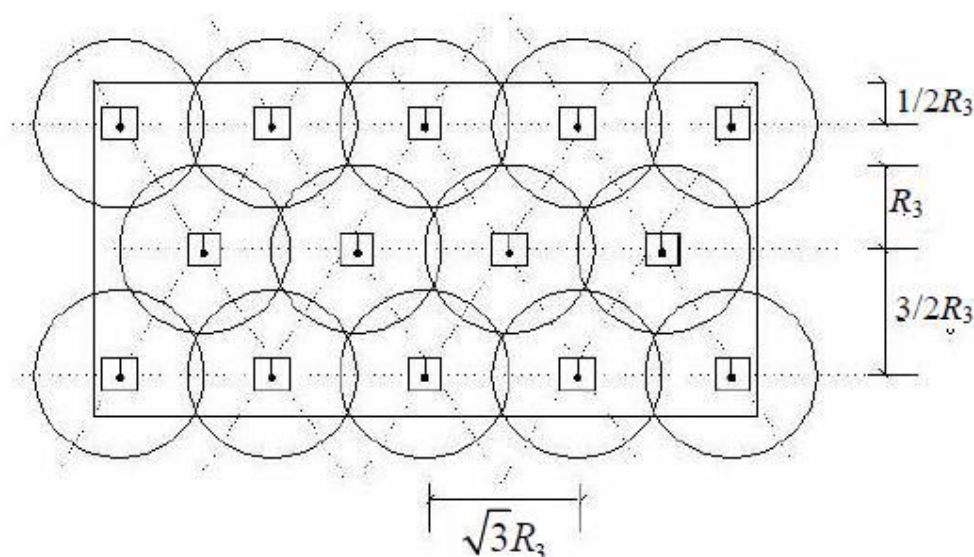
Схема однократного перекрытия защищаемой площади
